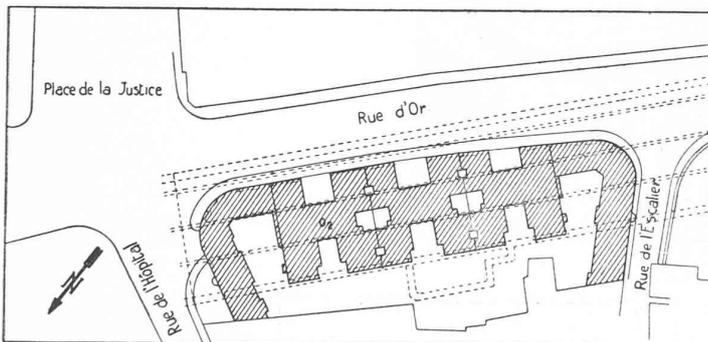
Plan de situation, du 20^e au 28^e étage.Fig. 15. — Plan de situation, du 7^e au 12^e étage.
